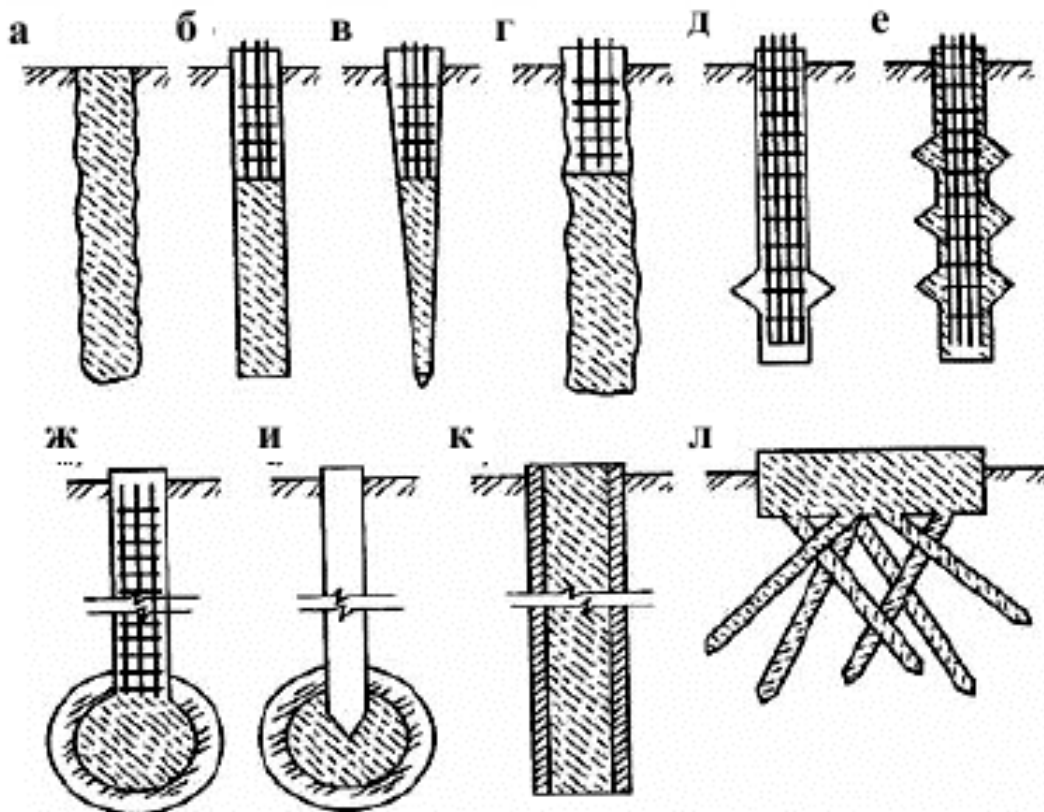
Набивні палі: а – бетонна; б – залізобетонна циліндрична; в – конічна; г – із профільованою поверхнею; д – з одним розширенням; е – з декількома розширеннями; ж – із камуфлетним розширенням; и – комбінована камуфлетна; к – в залізобетонній оболонці; л – коренеподібні палі
